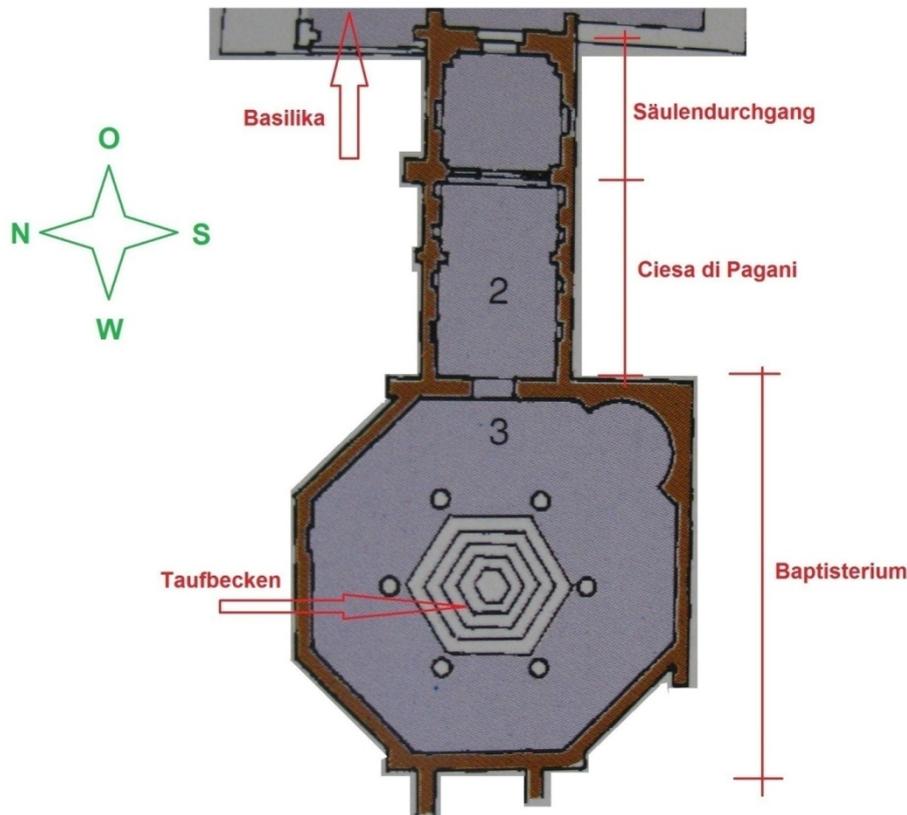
nicht maßstäblicher Grundriss Baptisterium und Chiesa dei Pagani
